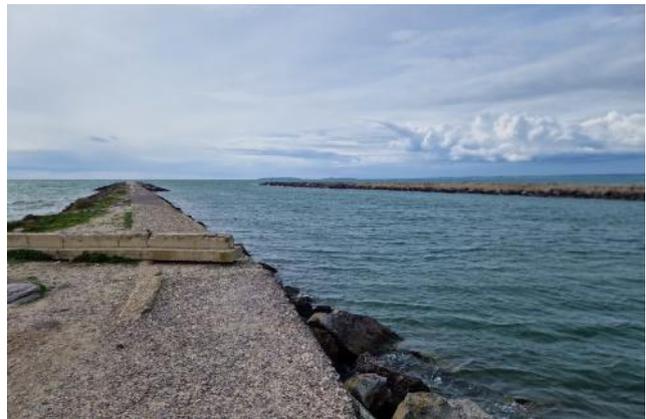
Particolare delle opere di stabilizzazione della foce del Canale di Pesaria.
